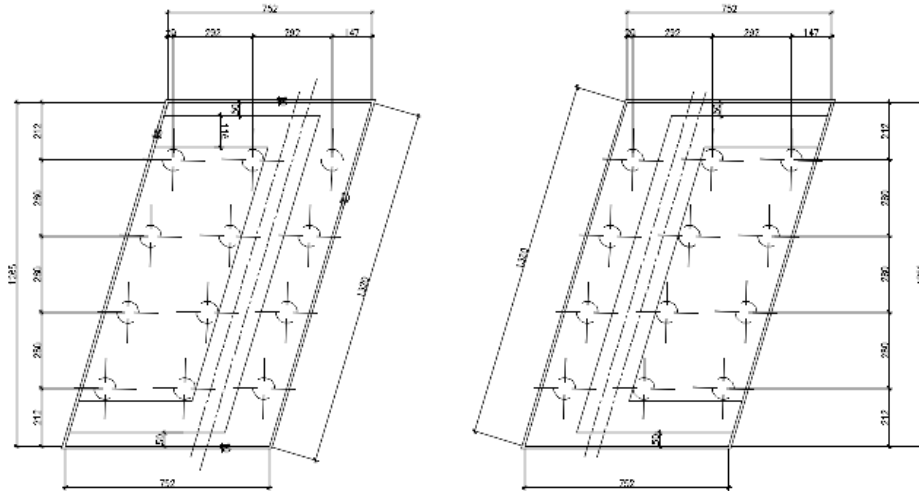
Ponte Cason Sud – Pianta Fondazioni
